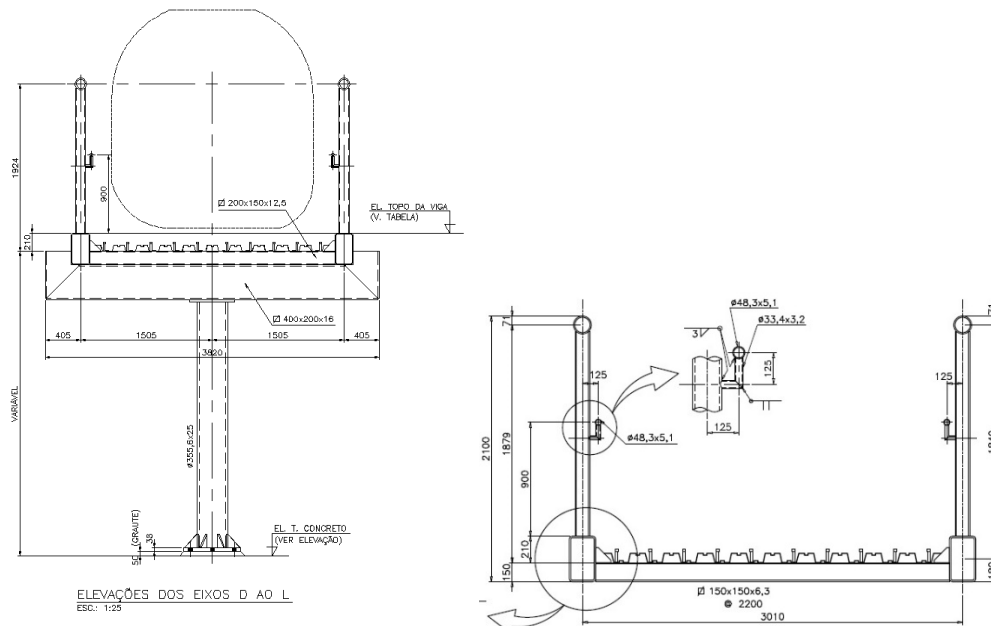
Elevação Lateral - Vão Típico da Via Elevada
